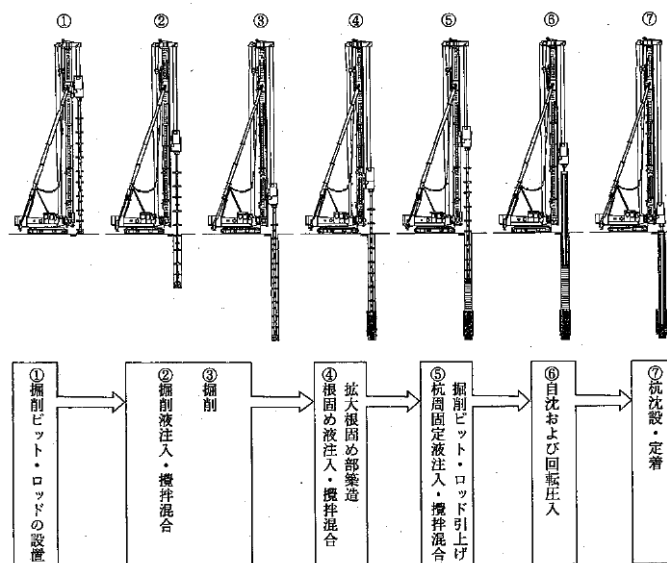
プレボーリング杭工法の施工手順例 ^{2.12)}
